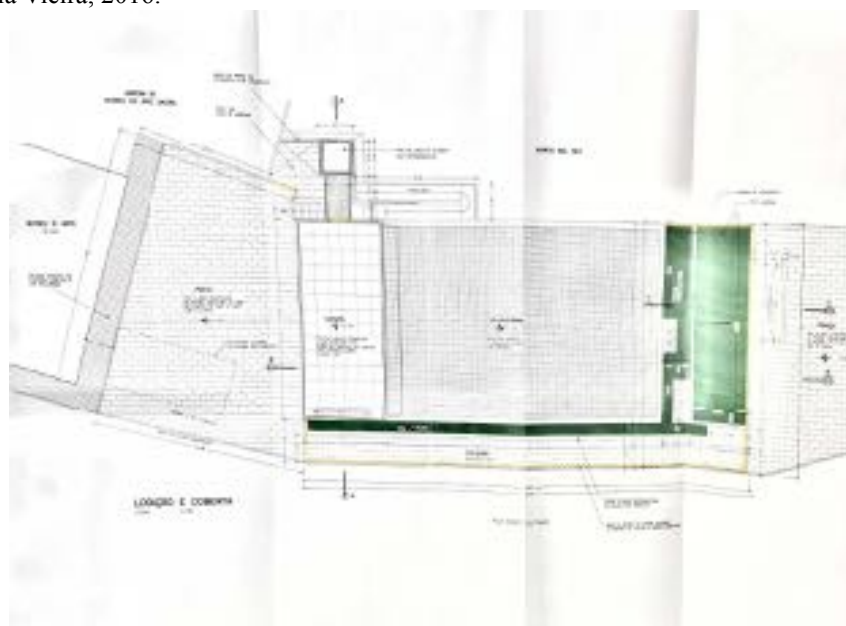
Planta de locação e coberta - projeto Grau Arquitetura aprovado em dezembro de 2003.
